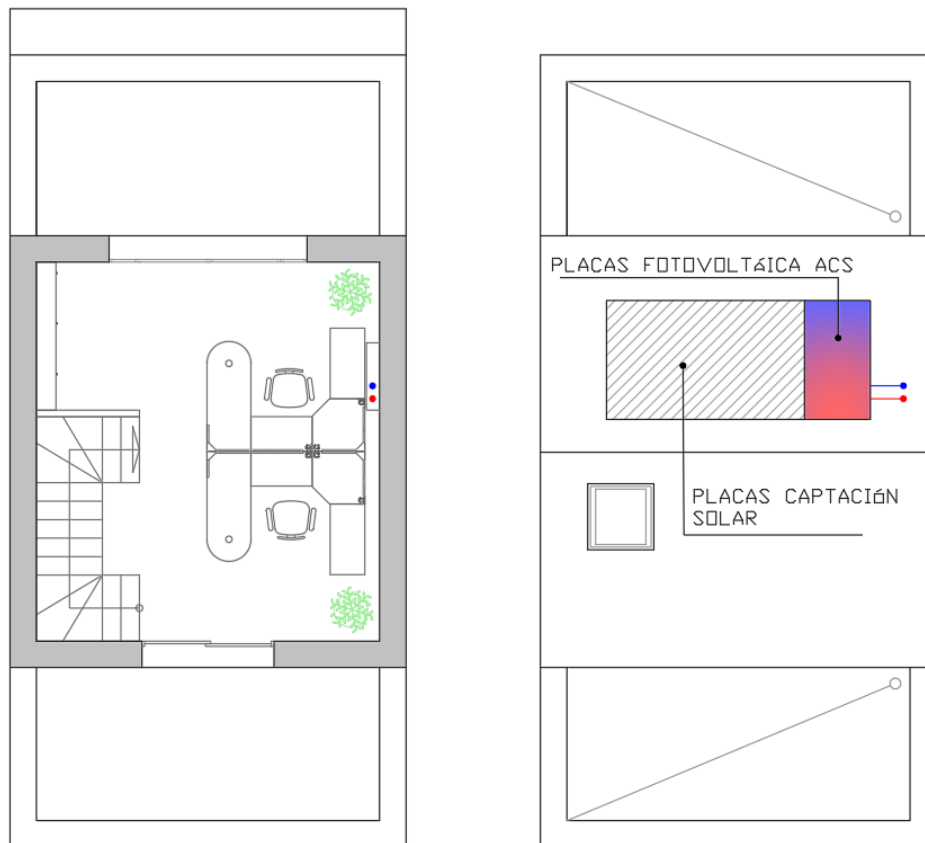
Esquema instalación agua fría y ACS planta ático y cubierta. 2019. Fuente propia.
